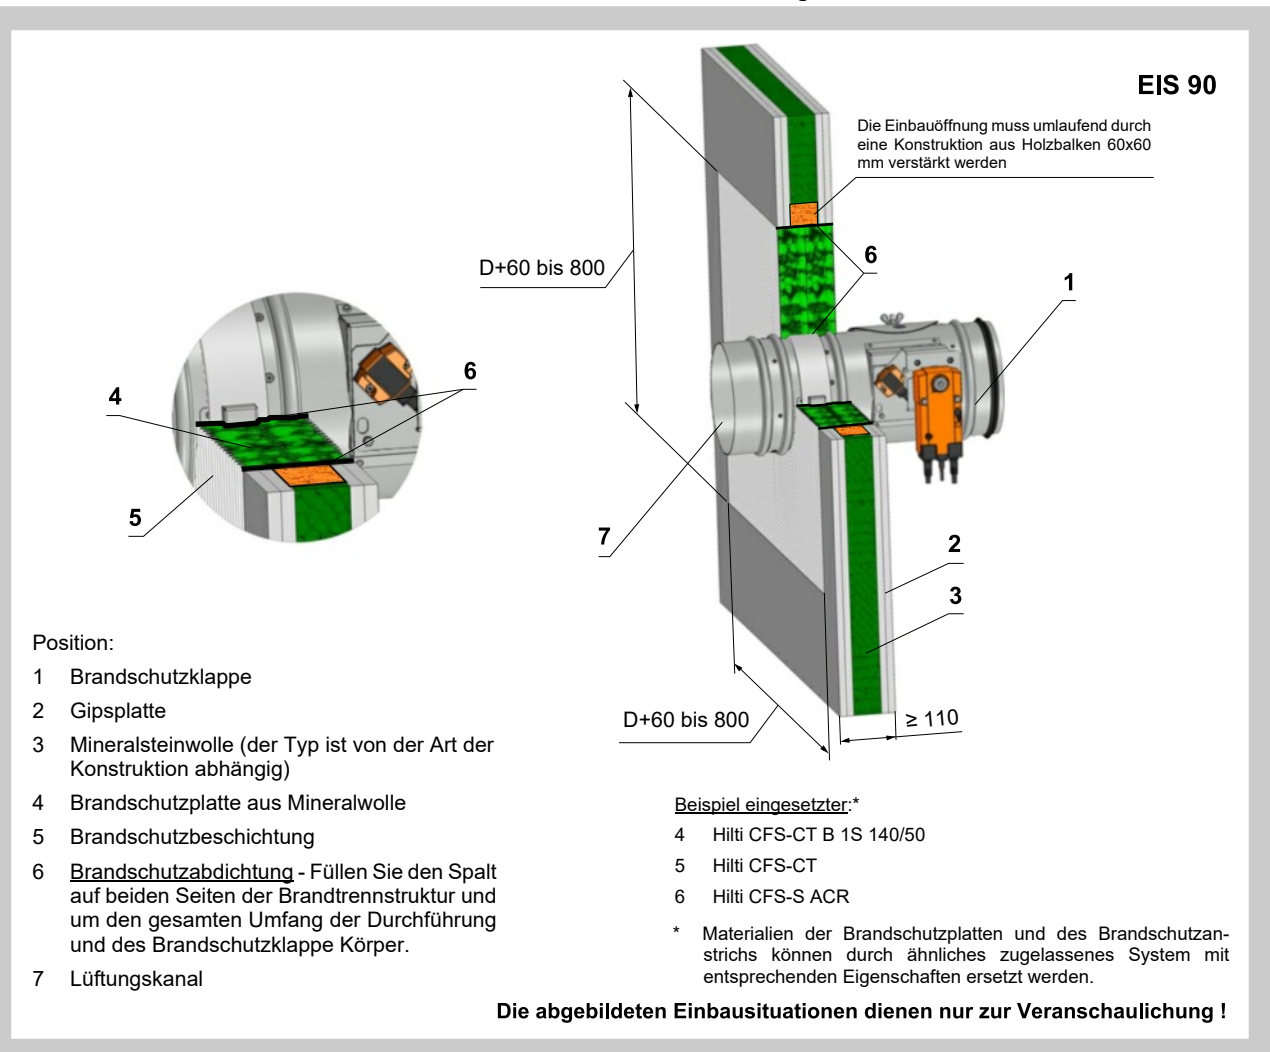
Lichtbauwand mit Holzbalkenkonstruktion in der min. Abmessung der Balken 60x60 mm – und Weichschott
